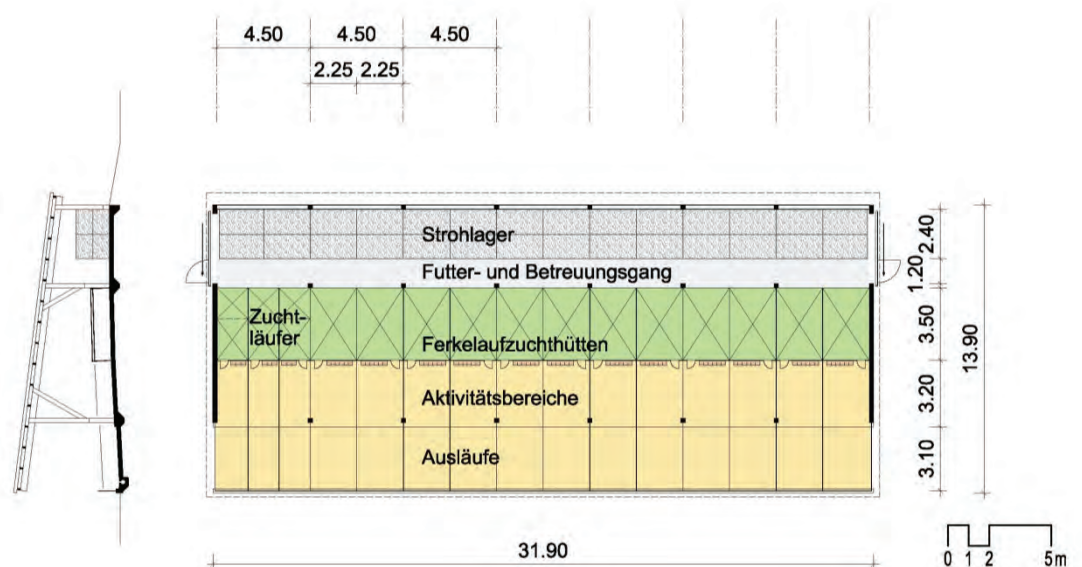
Grundriss und Schnitt des Ferkelaufzucht-Stallabteils
